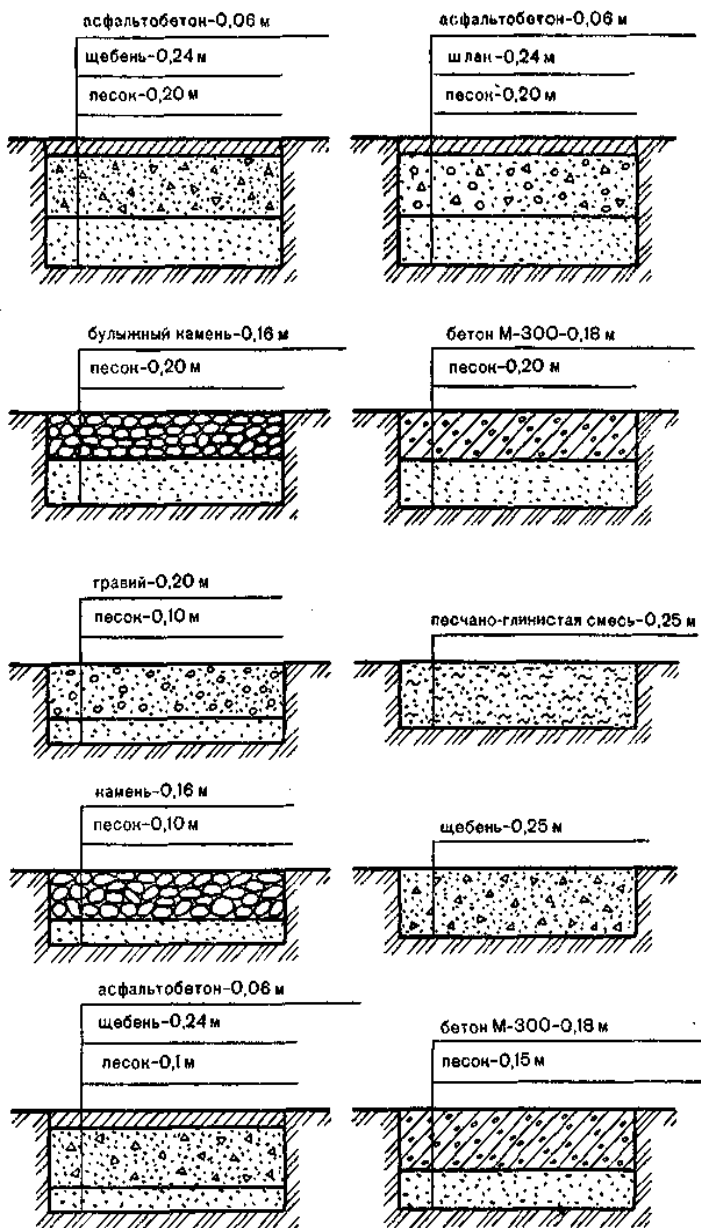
Схемы покрытий площадок для хранения техники
